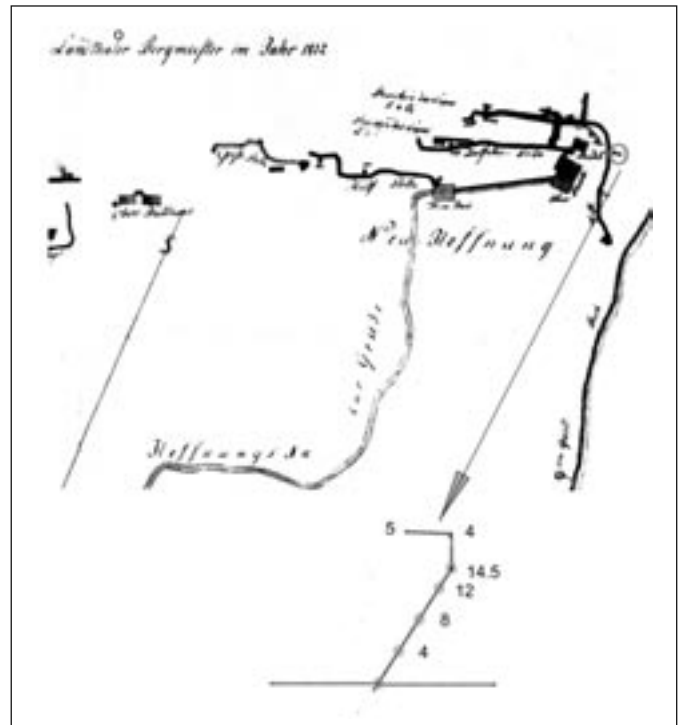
Ausschnitt aus dem Landthalerplan von 1812 mit Tiefenstollen, Vorstollen und schrägem (donlegigem) Sondierschacht mit Leitern (Fahrten).
